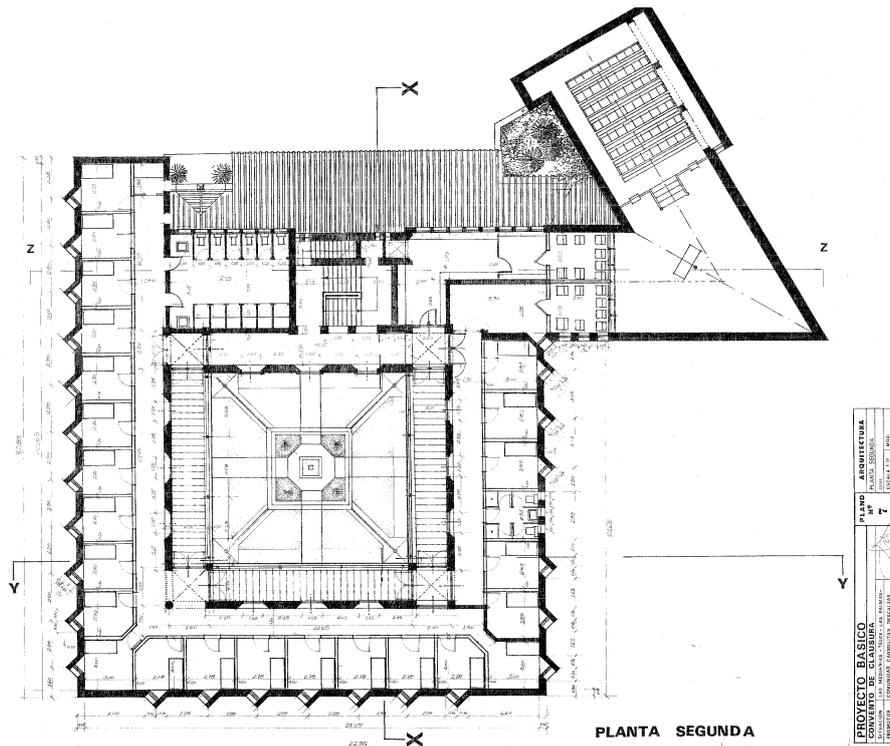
Convento Carmelita de Telde. Plano de planta segunda.
